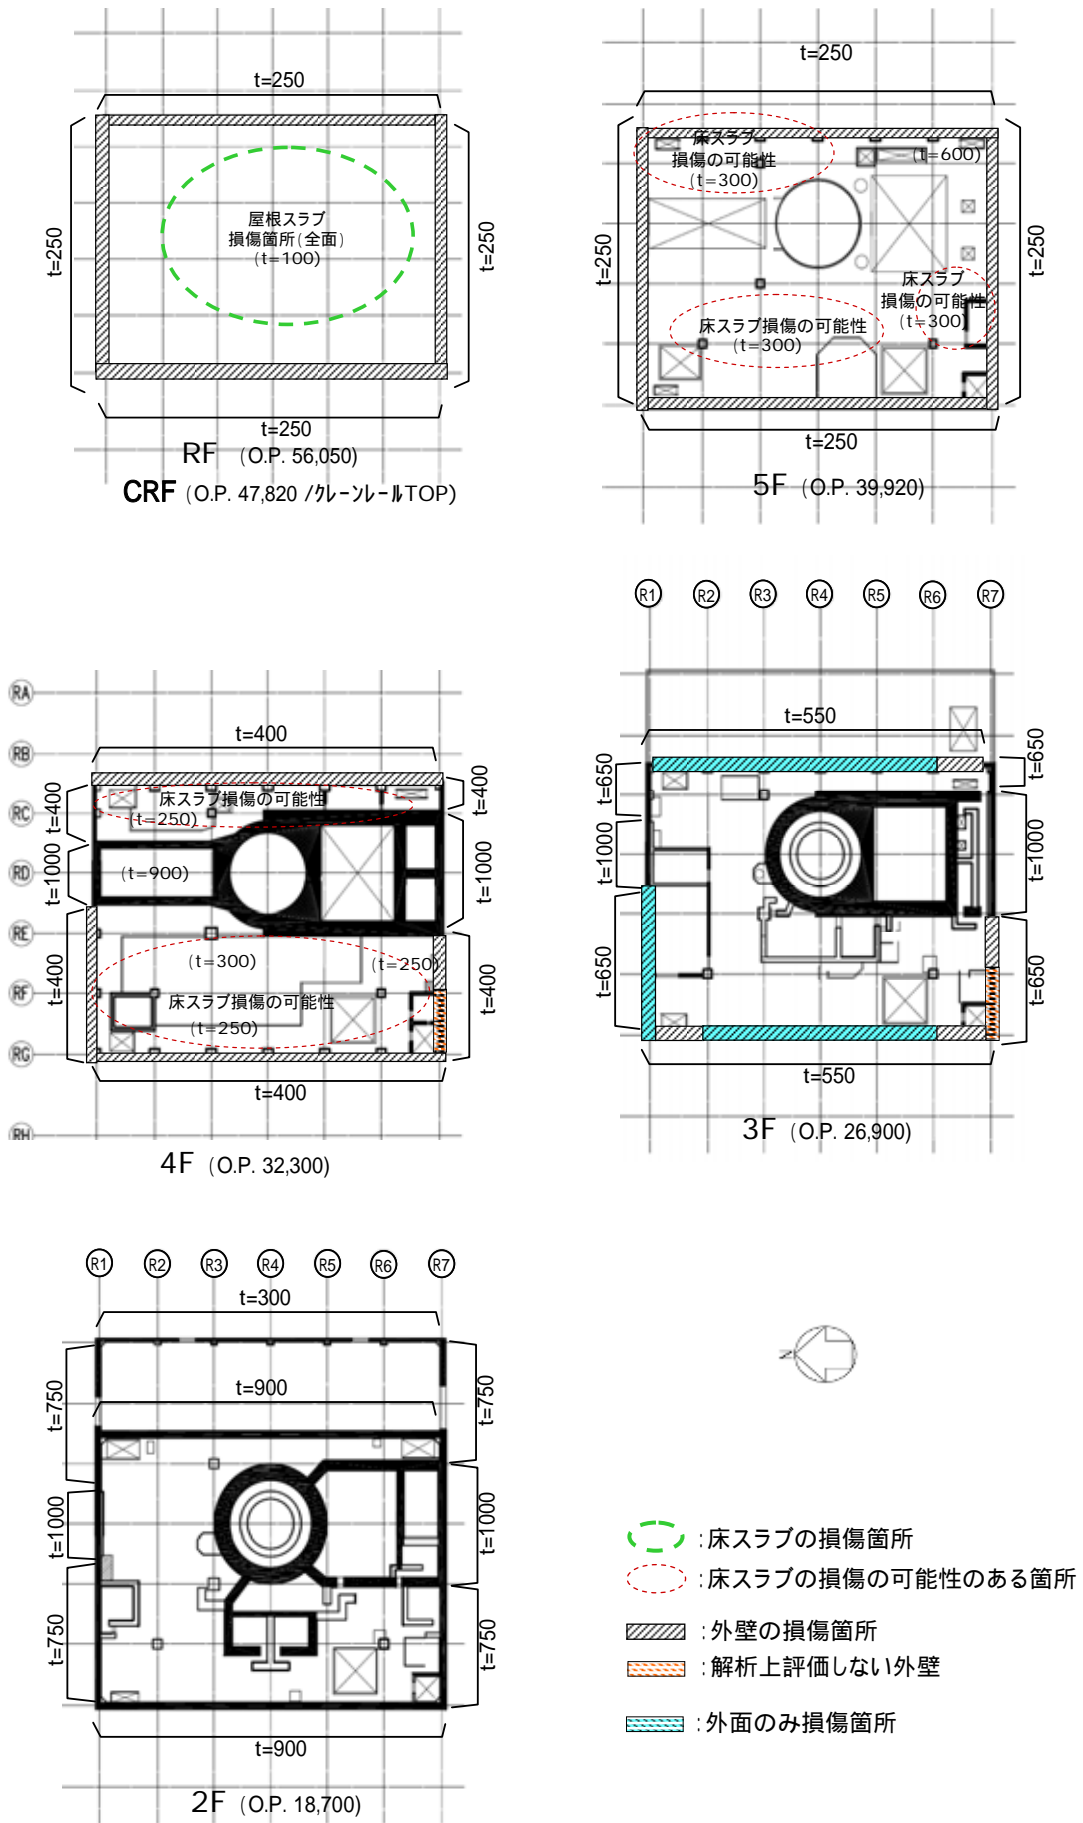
4号機原子炉建屋の損傷状況(平面図)
